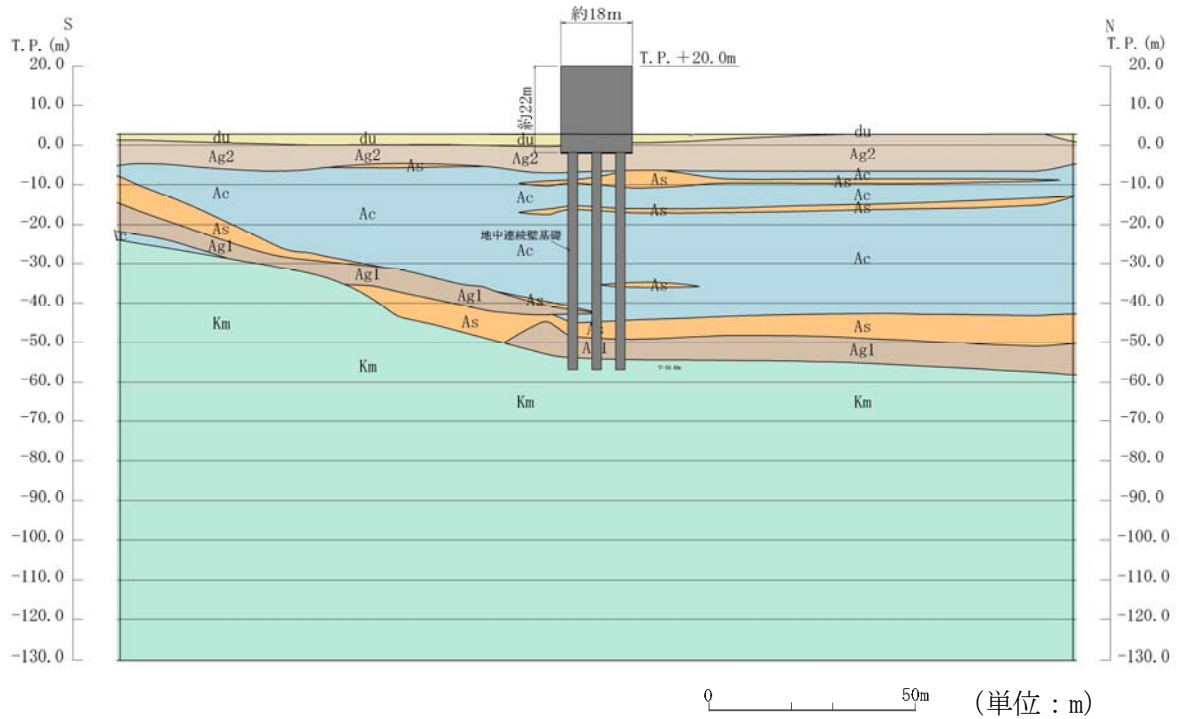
(3) 鉄筋コンクリート防潮壁 評価対象断面図 (③-③断面)
